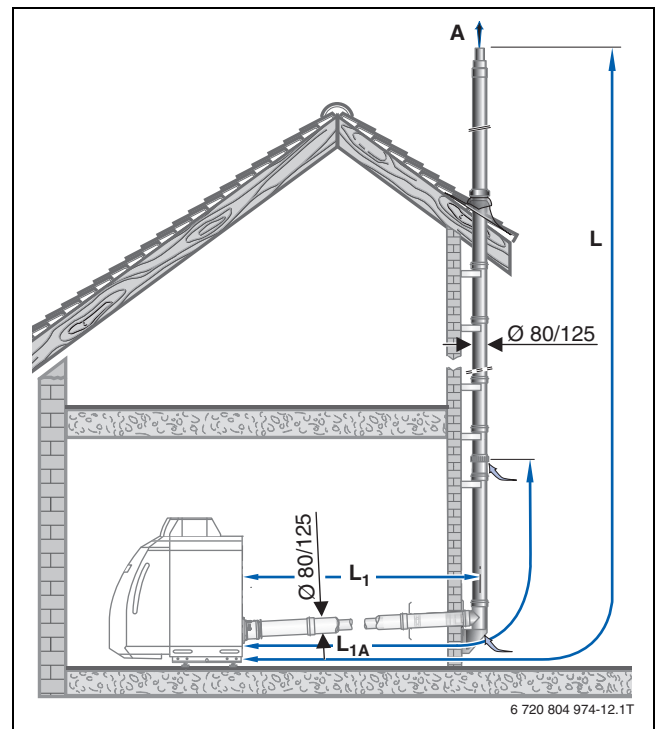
Conducción de tubo concéntrica en la fachada (C<sub>53(x)</sub>)
